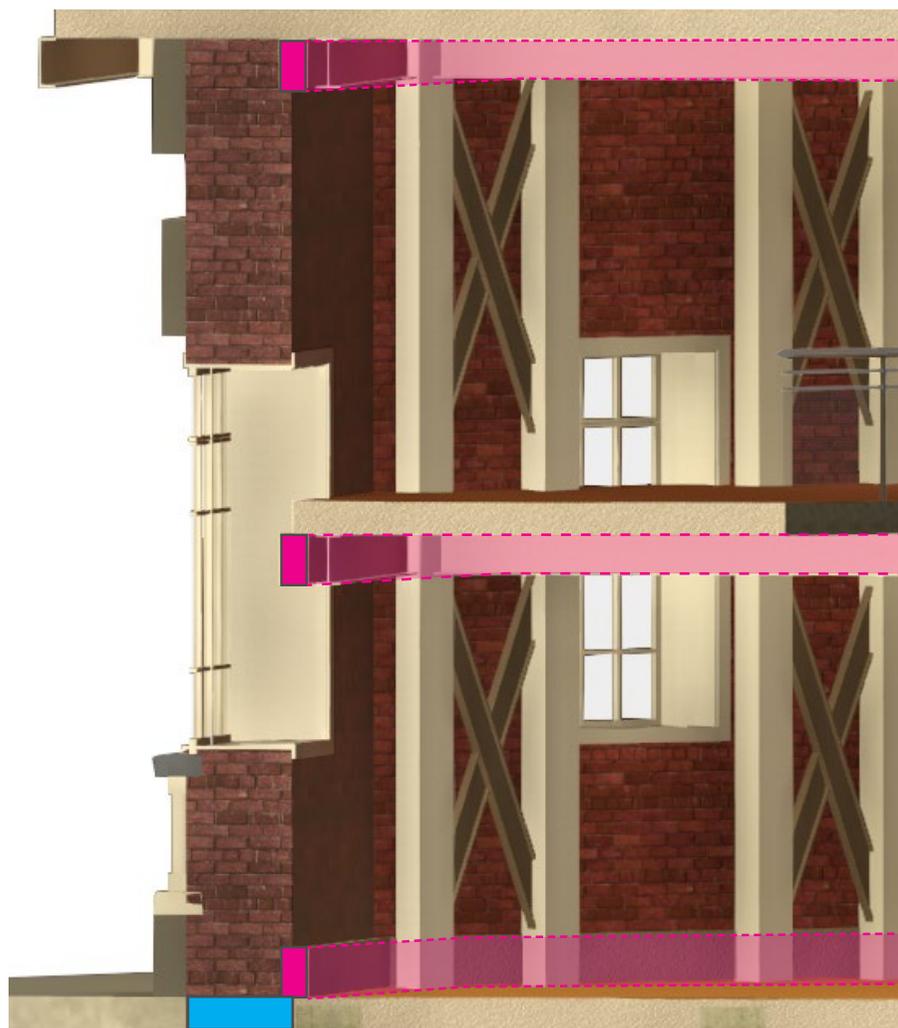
/5/6 :Render 3D, estructura metálica y en HA soportante propuesta para elementos de fachada histórica. *Fuente: E. en base a propuesta.
